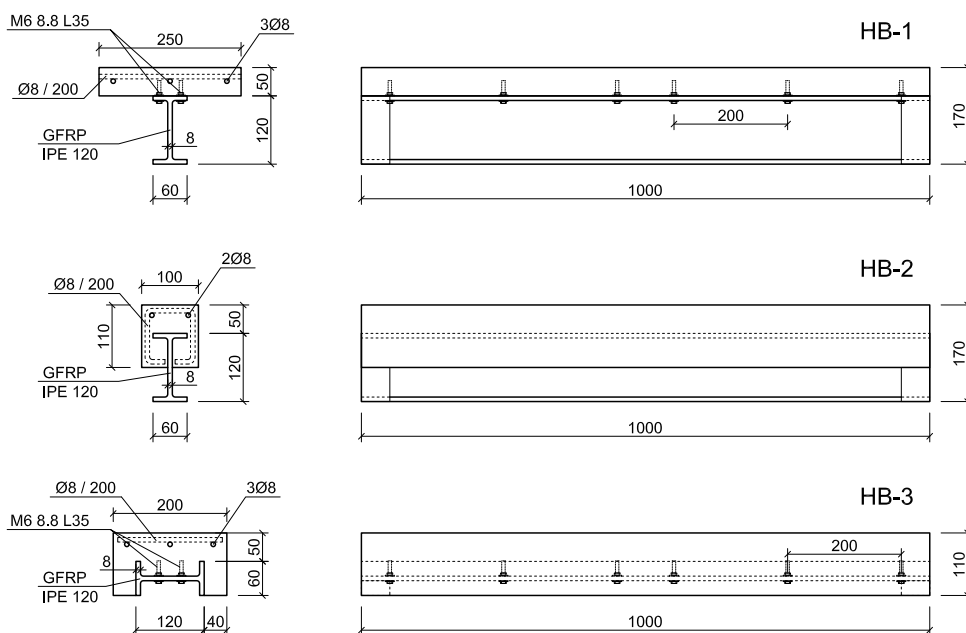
Detalles constructivos de las vigas híbridas a pequeña escala. Cotas en mm.
